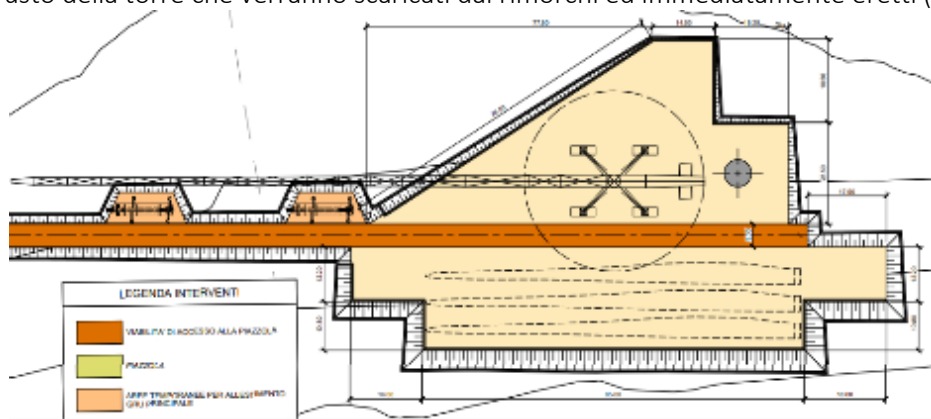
Planimetria in fase costruttiva: sistema di montaggio "Partial storage".
